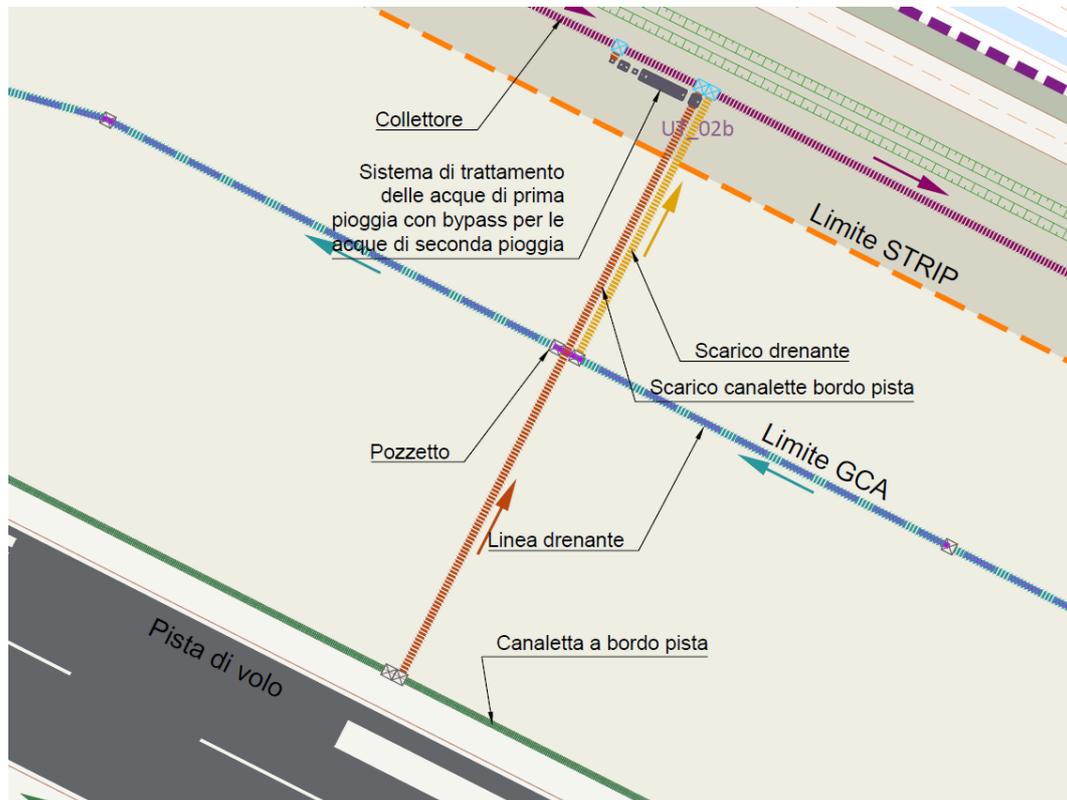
| Schema di funzionamento della rete di drenaggio a servizio della pista di volo.
